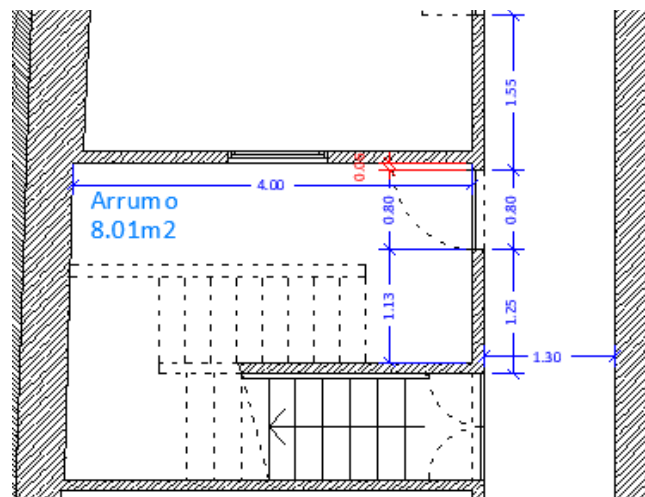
Dimensões em planta para a verificação da zona de manobra da porta do piso 1 (SRU, 2023).
